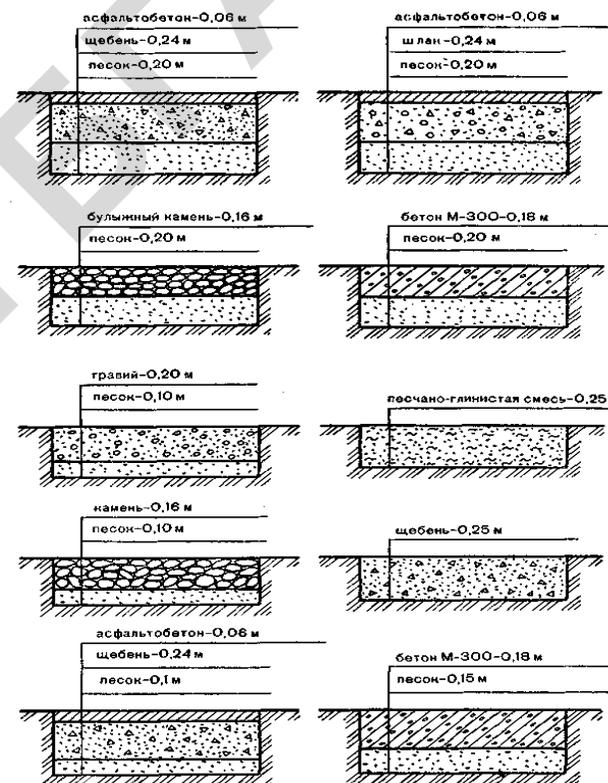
Схемы покрытий площадок для хранения техники
